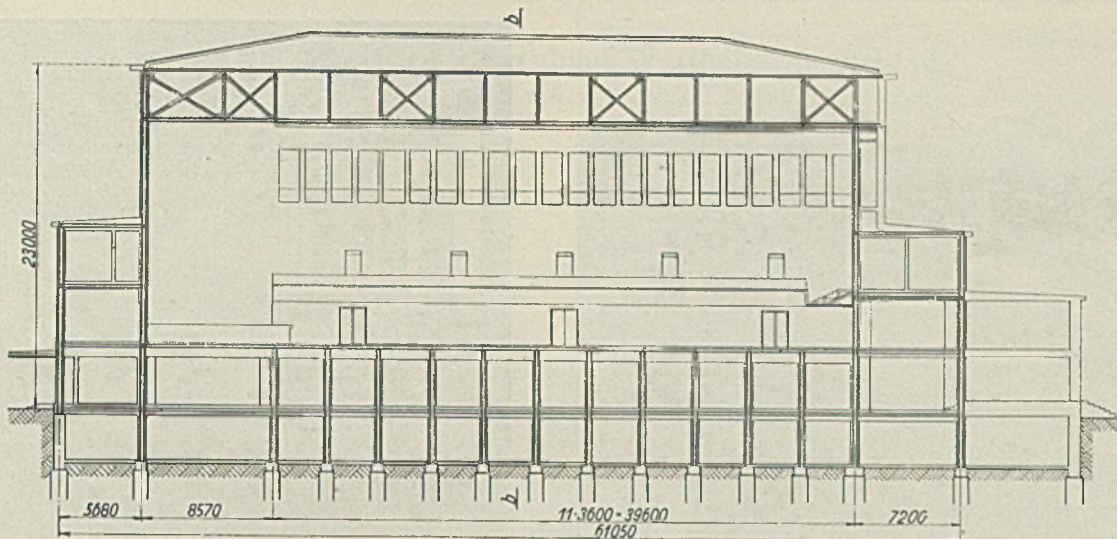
Längsschnitt a—a durch den Saalbau.
